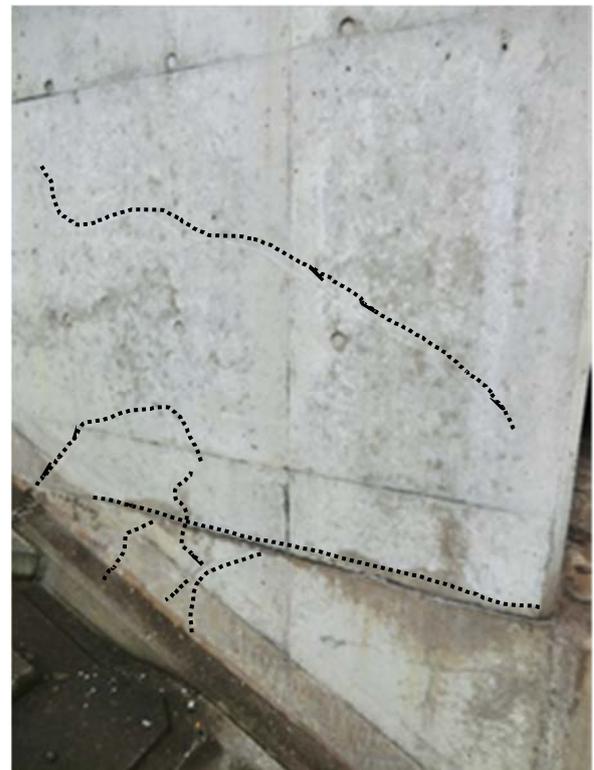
A1橋台下流側のひび割れ（厚真大橋）
